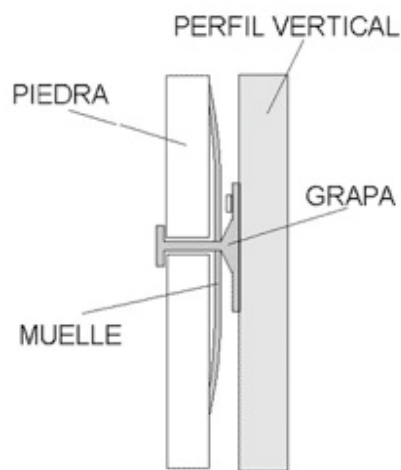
Grapa y muelle para soporte de aplacado de piedra.
